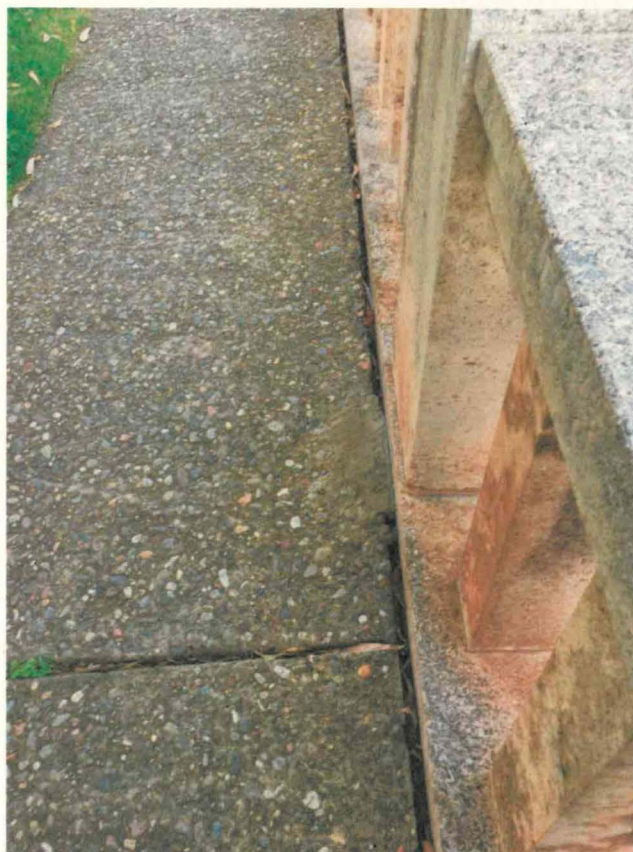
Distacco tra la parte sommitale del muro d'argine e la pavimentazione –
